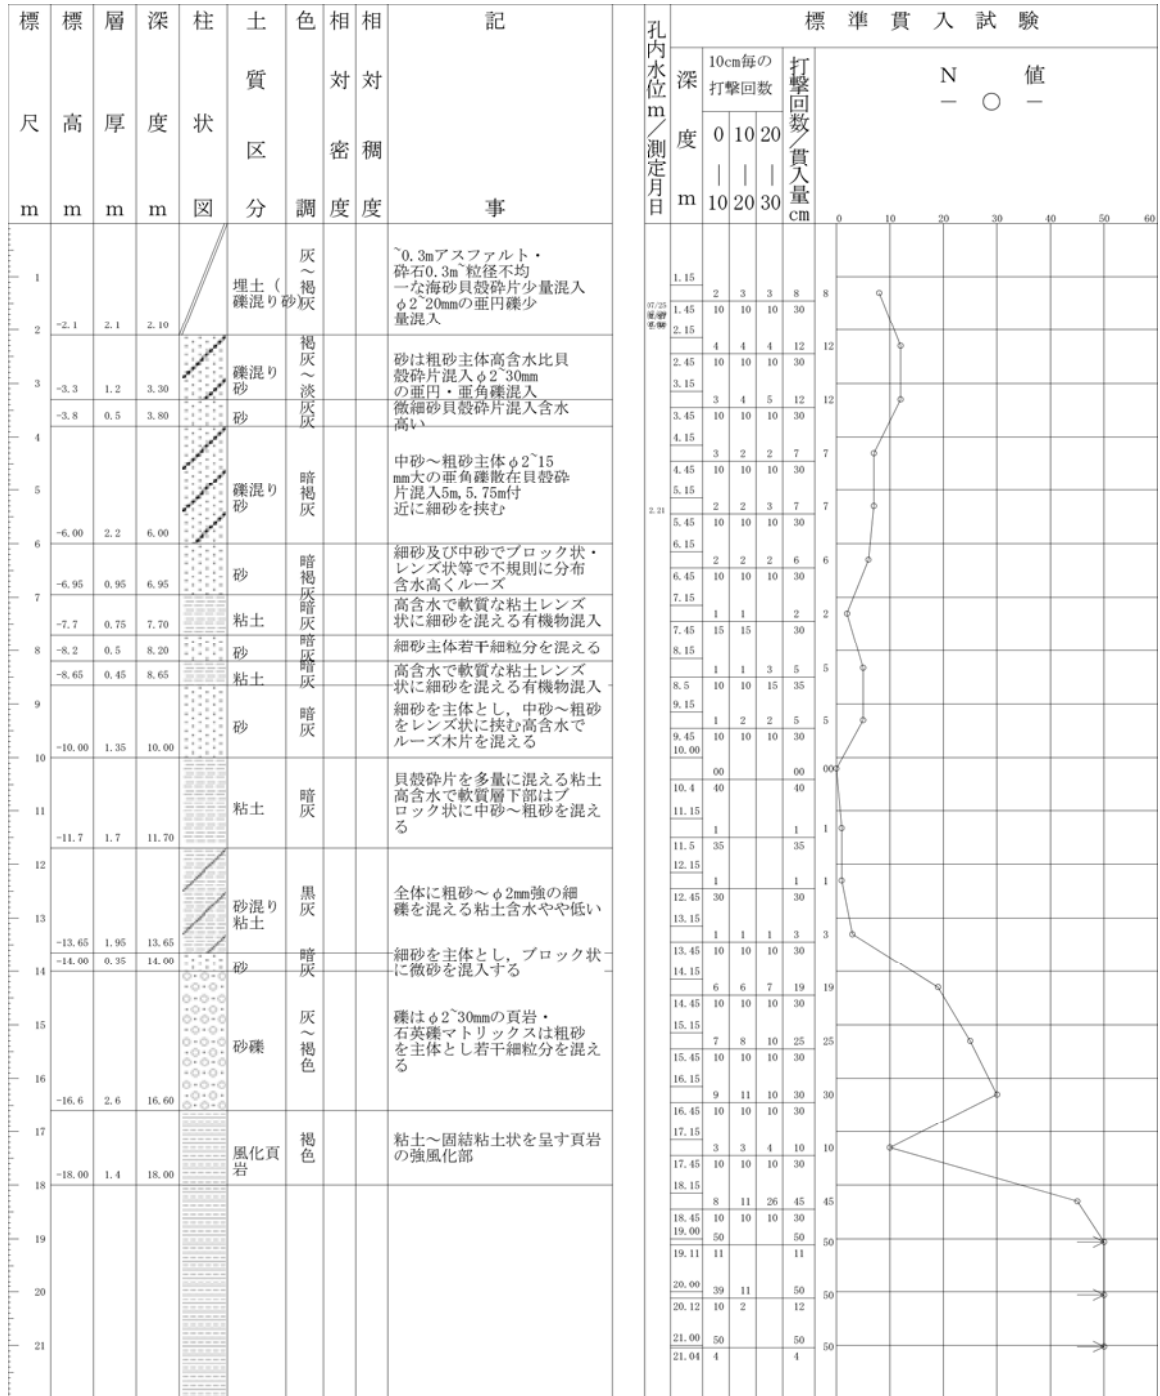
箱崎埠頭-7.5m岸壁のボーリング柱状図① (位置は図-4.3.1参照)
